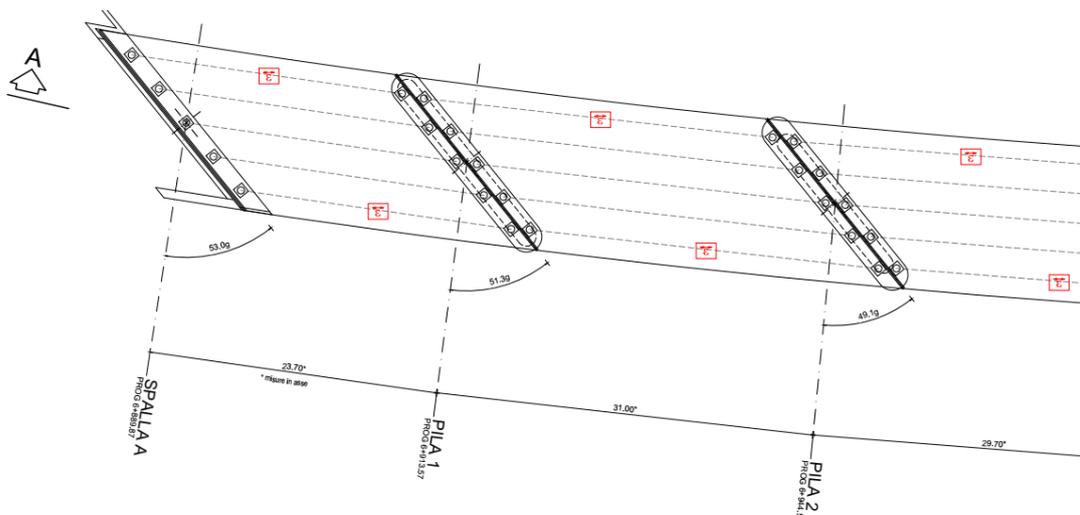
Ubicazione sensori su impalcato sezione a 6 travi (pianta viadotto Collestrada)
